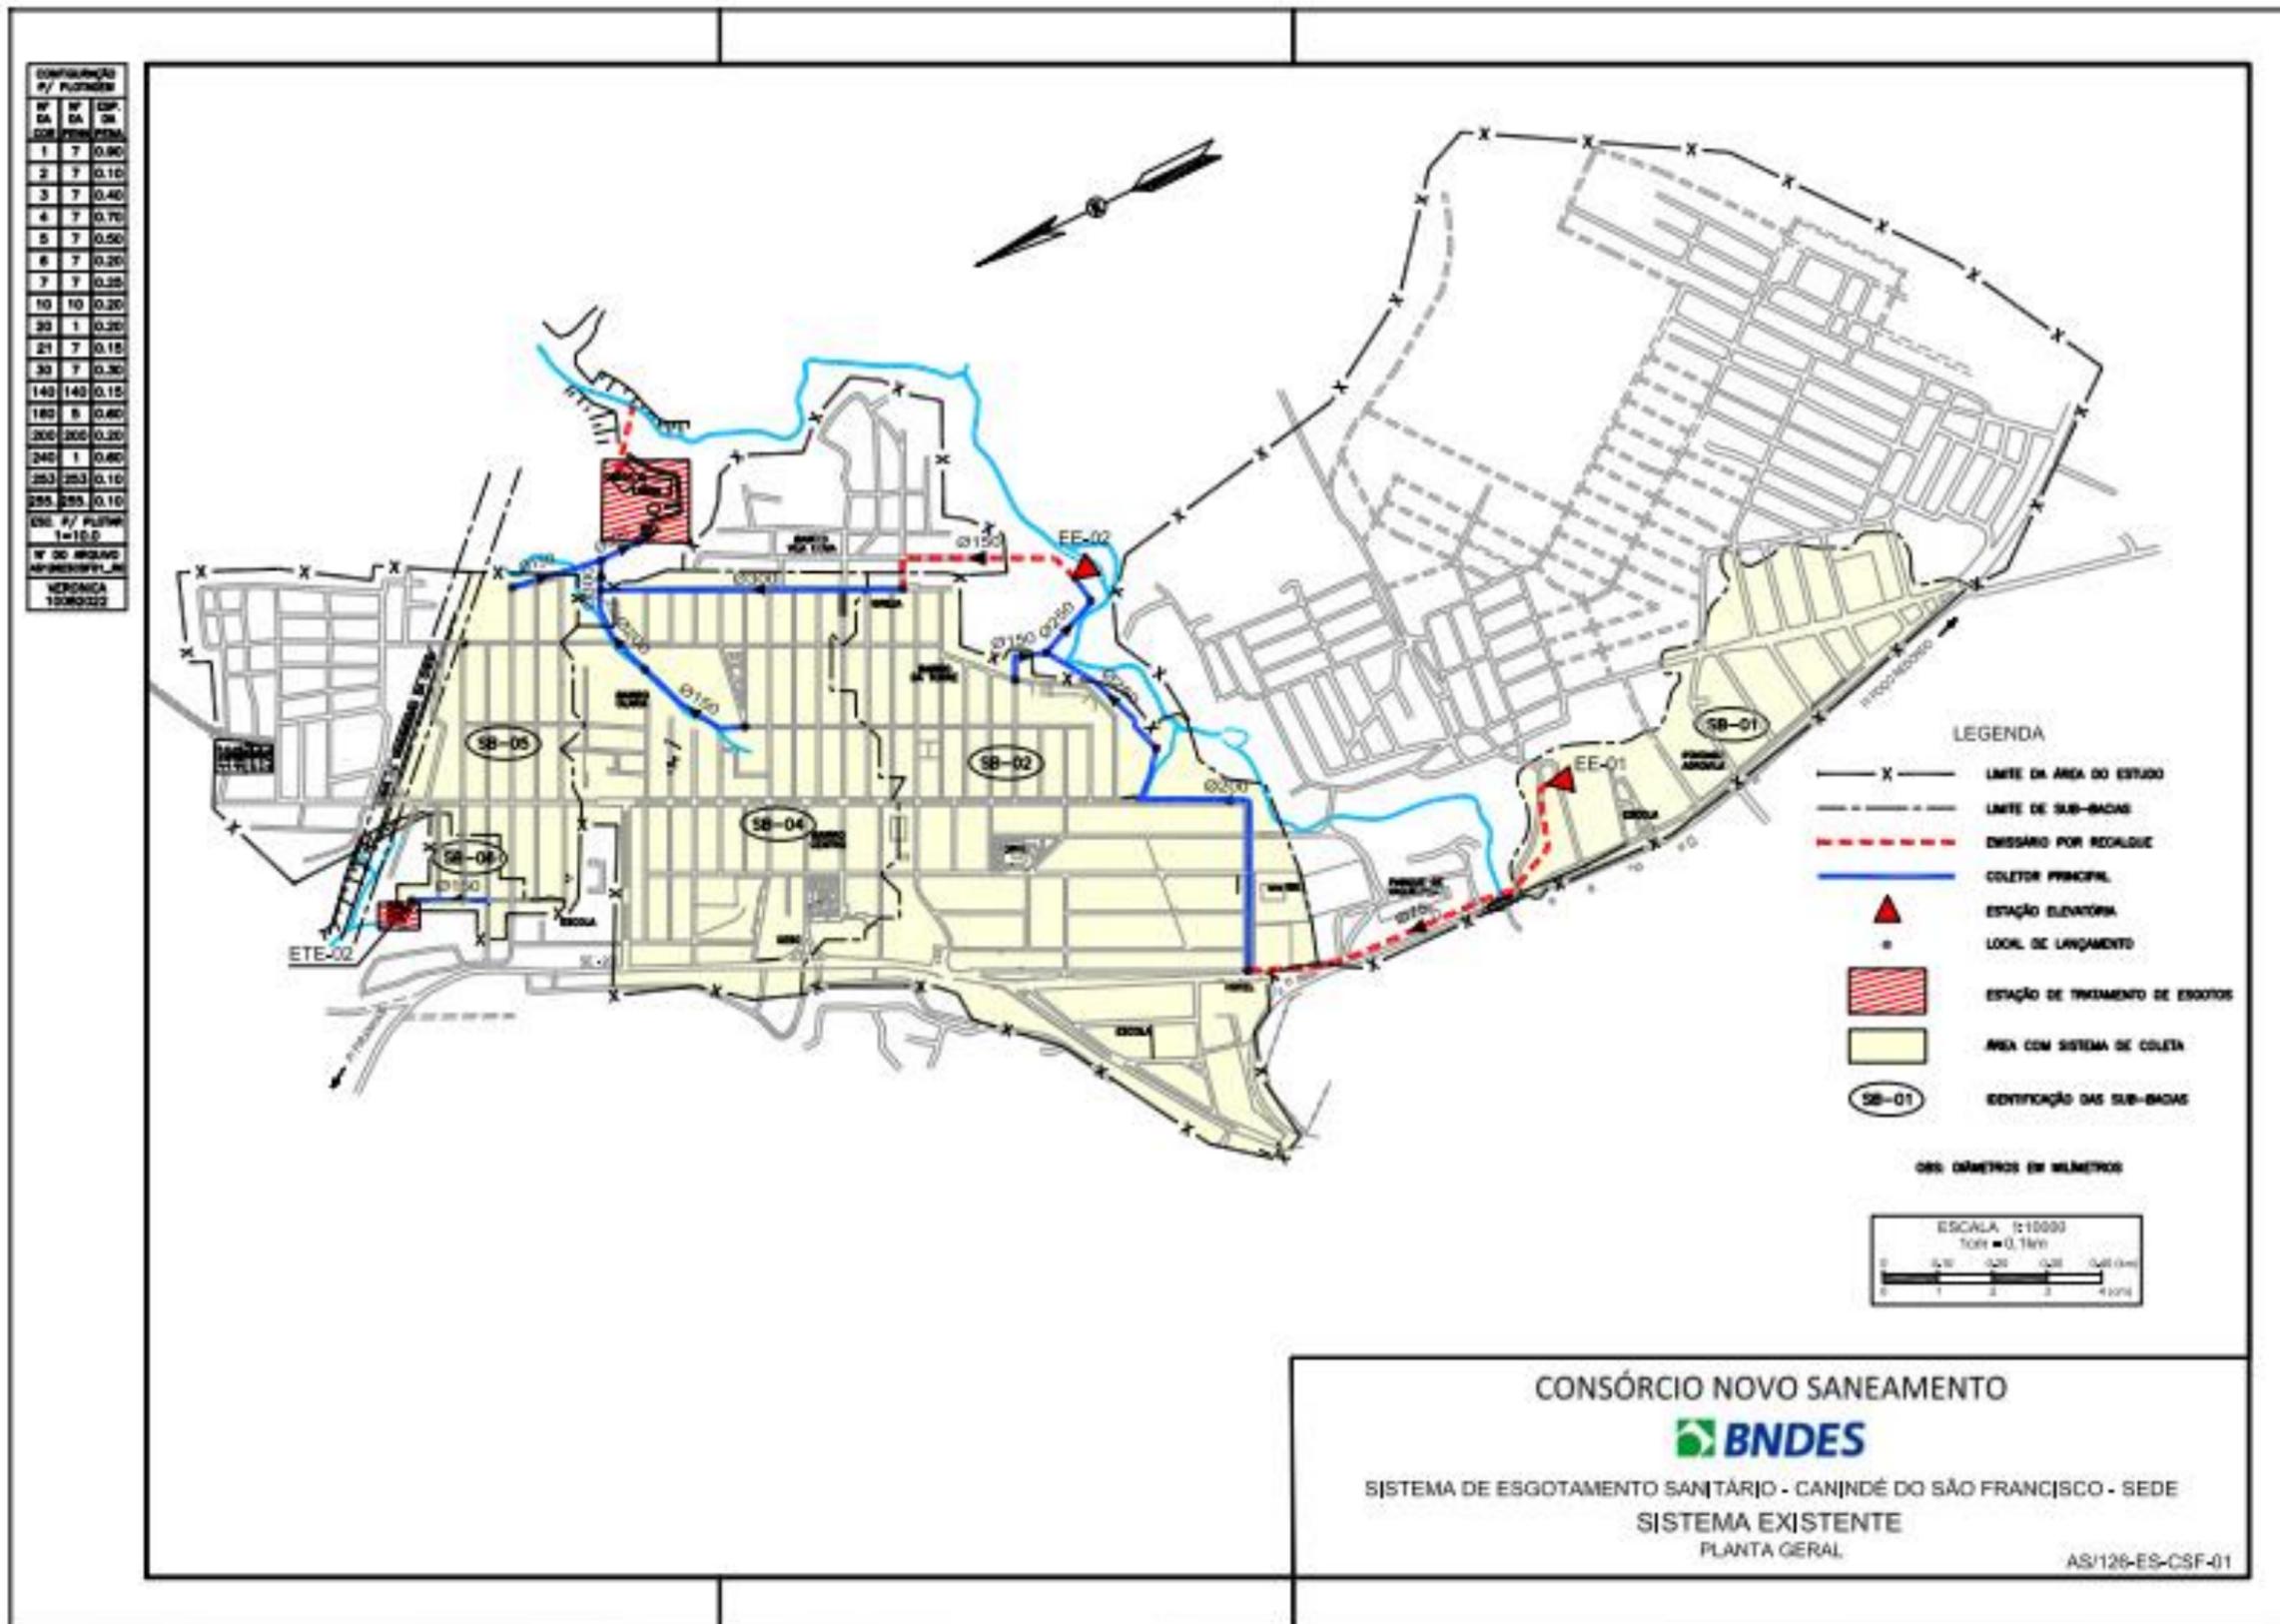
Planta do Sistema de Esgotamento Sanitário – CANINDÉ DO SÃO FRANCISCO
